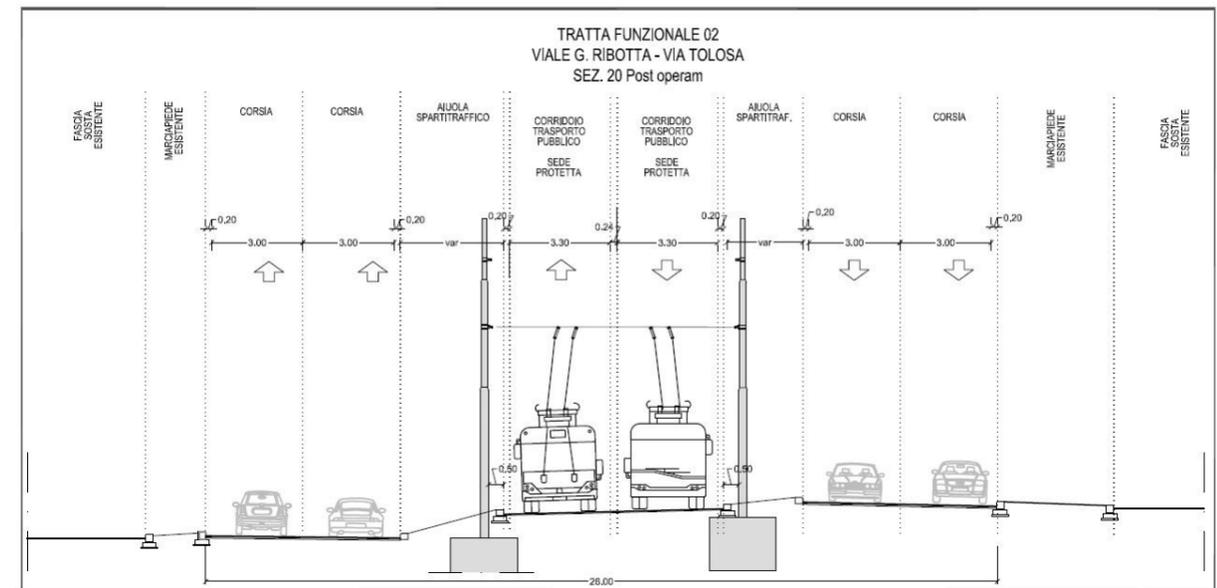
sezione trasversale via Ribotta - via Tolosa
